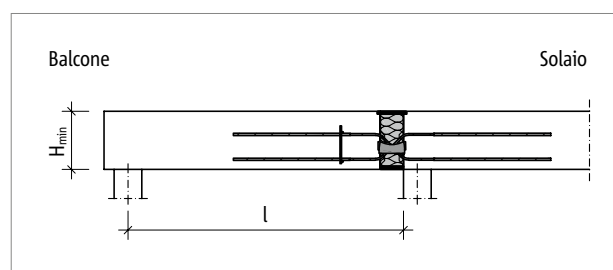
Schöck Isokorb® T tipo QL-VV2 – VV6: sistema statico
